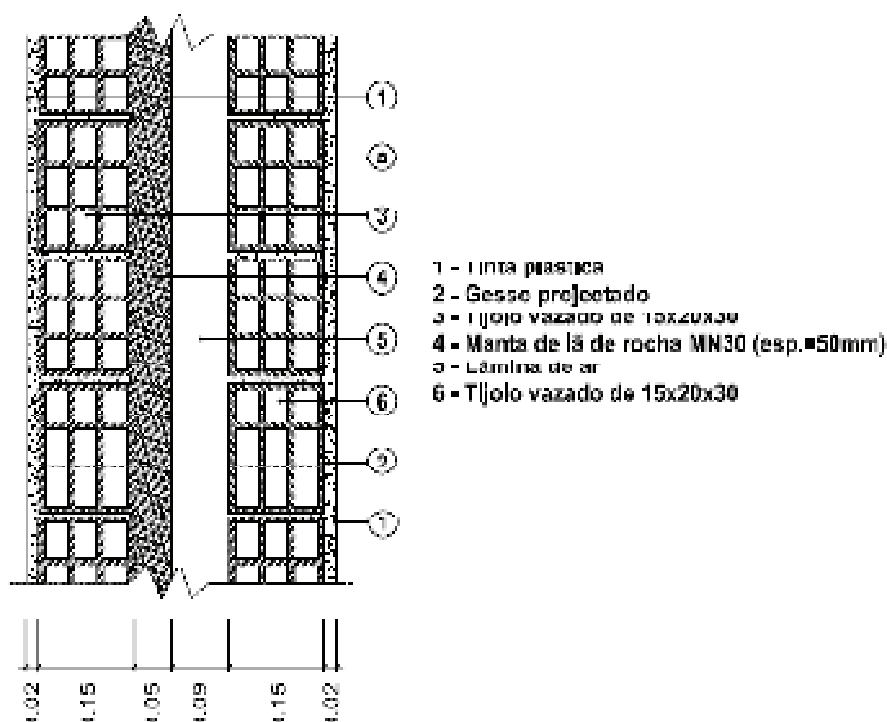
Pormenor construtivo de parede entre habitações de blocos diferentes.
